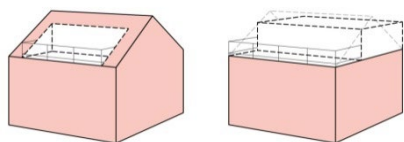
Transformation de la toiture. Une toiture en pente est coupée ou une toiture en pente est transformée en toiture plate avec attique.
